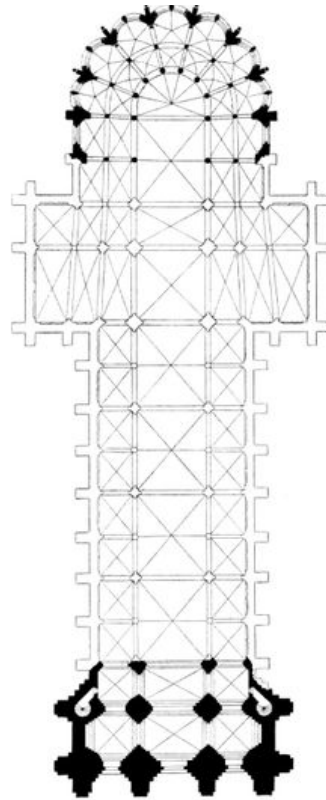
Planta Igreja Saint-Denis (Reconstrução de Abade Suger). Paris, 1144
